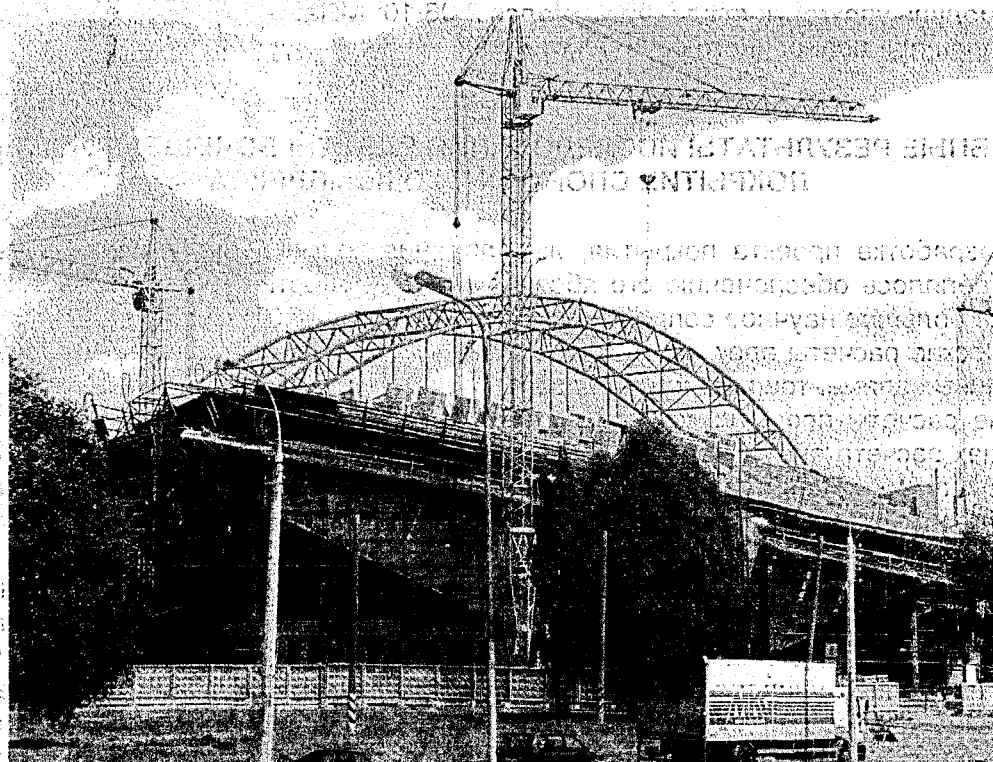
Общий вид покрытия с испытательной нагрузкой
